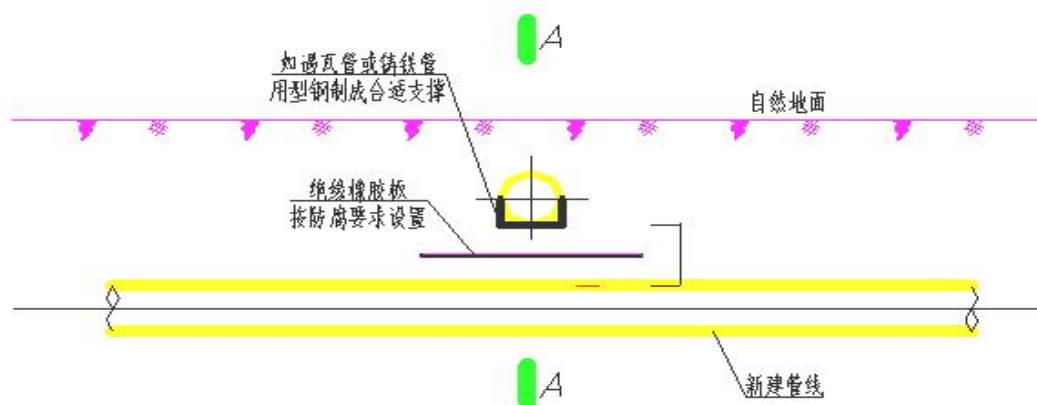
管道与现有管道交叉穿越断面示意图
